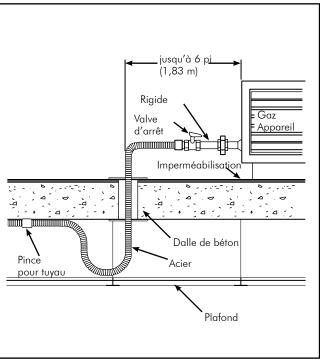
Raccordement extérieur court, de 1 à 6 pi (0,30 m à 1,83 m) vers un équipement installé sur le toit
